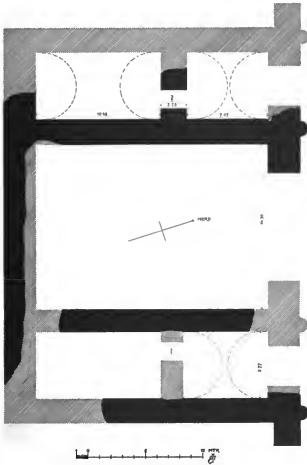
Bau A („Sommerpalast“), Grundriß.
